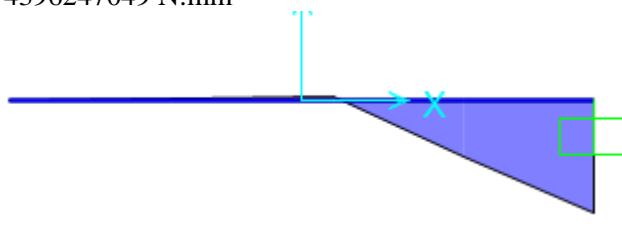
35 Pembebanan Poer Kolom Tipe II (Arah Sumbu X)
